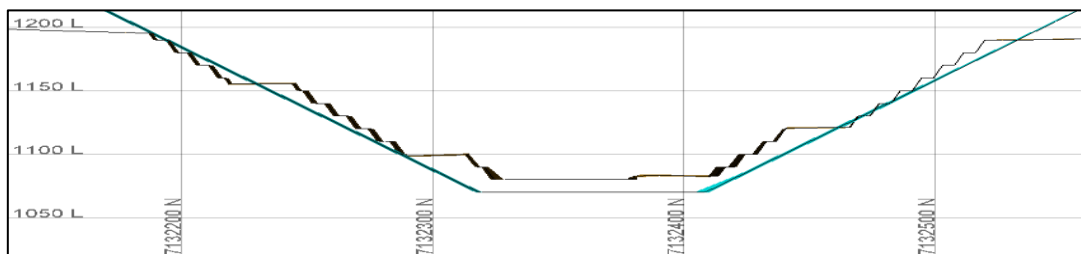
LG1Y Fase 1 - Vista en sección - Corte principal N-S E394100
